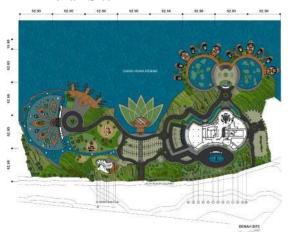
Siteplan Rawa Pening Resort Hotel Sumber: Analisa Penulis, 2020
